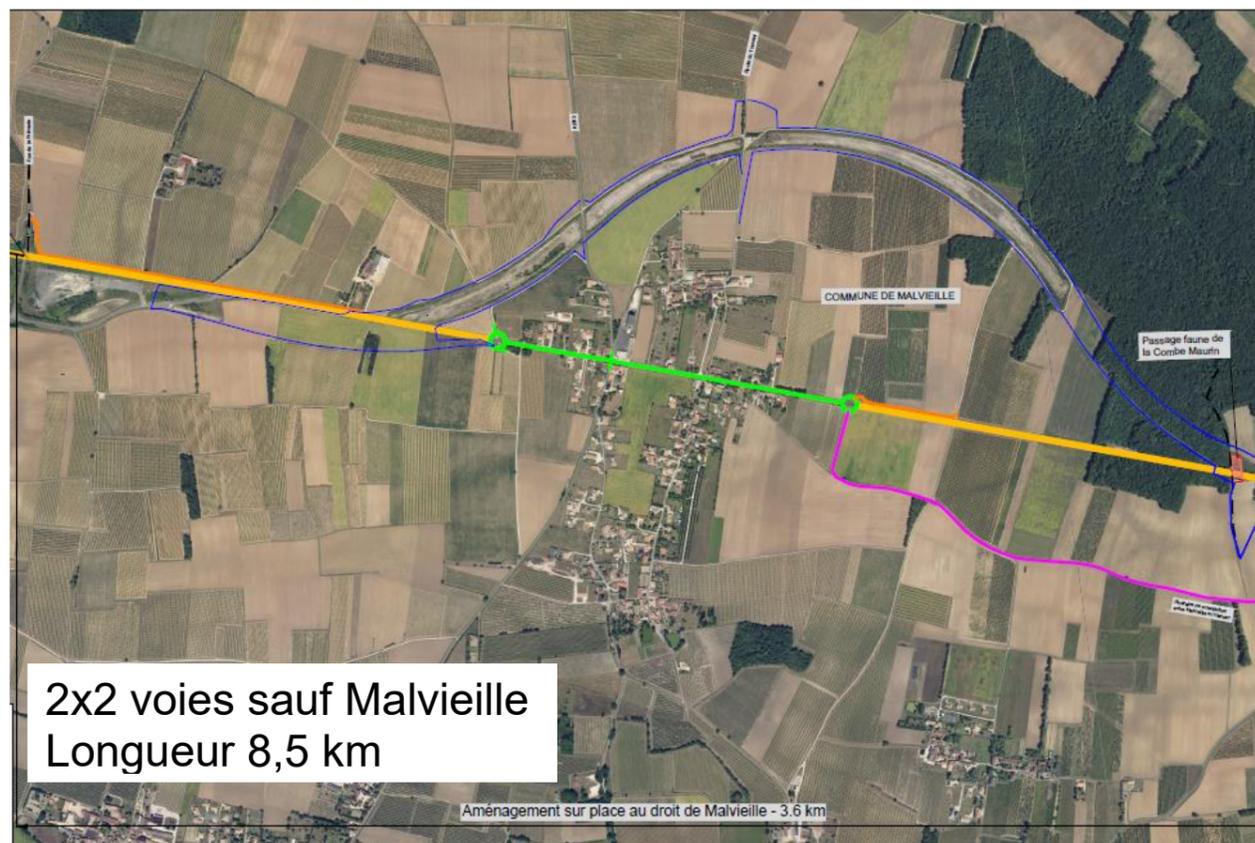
Plan variante aménagement sur place de Malvieille et Hiersac
